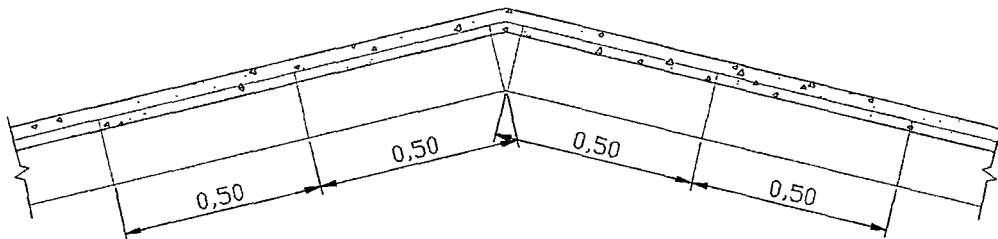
Corte Transversal Típico del Techo de un Campamento Minero
